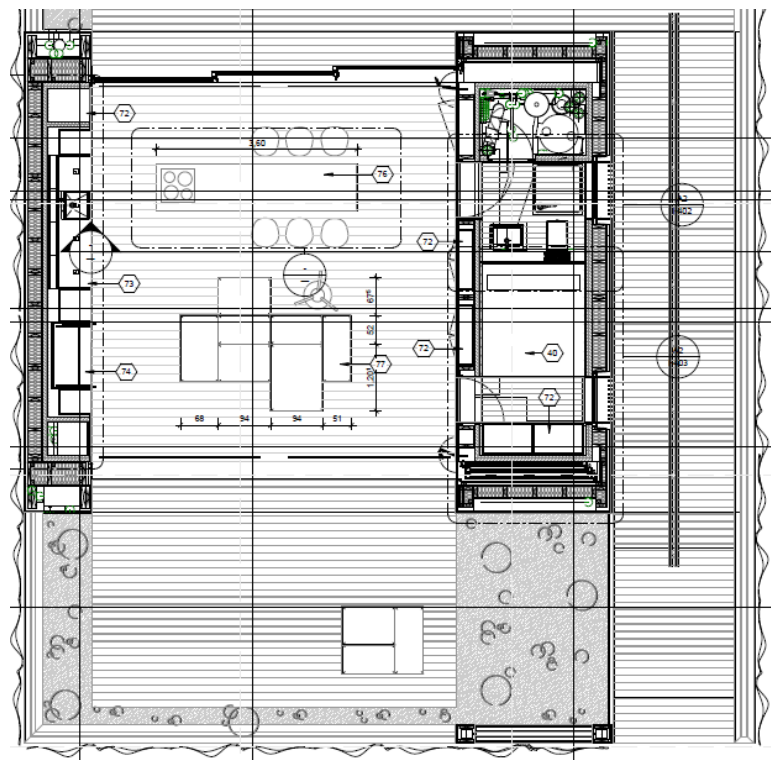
Lisi, pianta arredata.<sup>9</sup>
